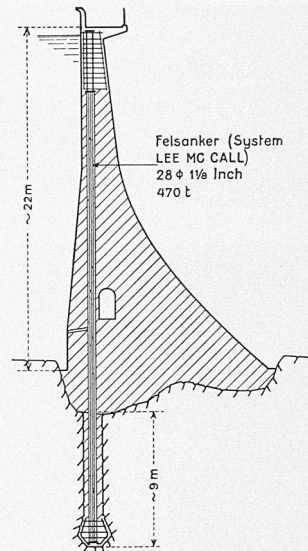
Staumauer Allt-Na-Lairige (Schottland)
